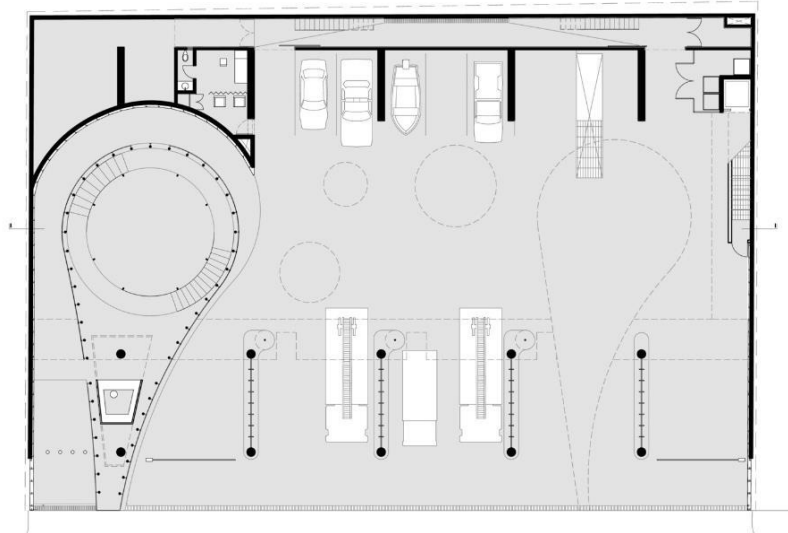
Estación de Bomberos Ave Fénix. Plano de primera planta
